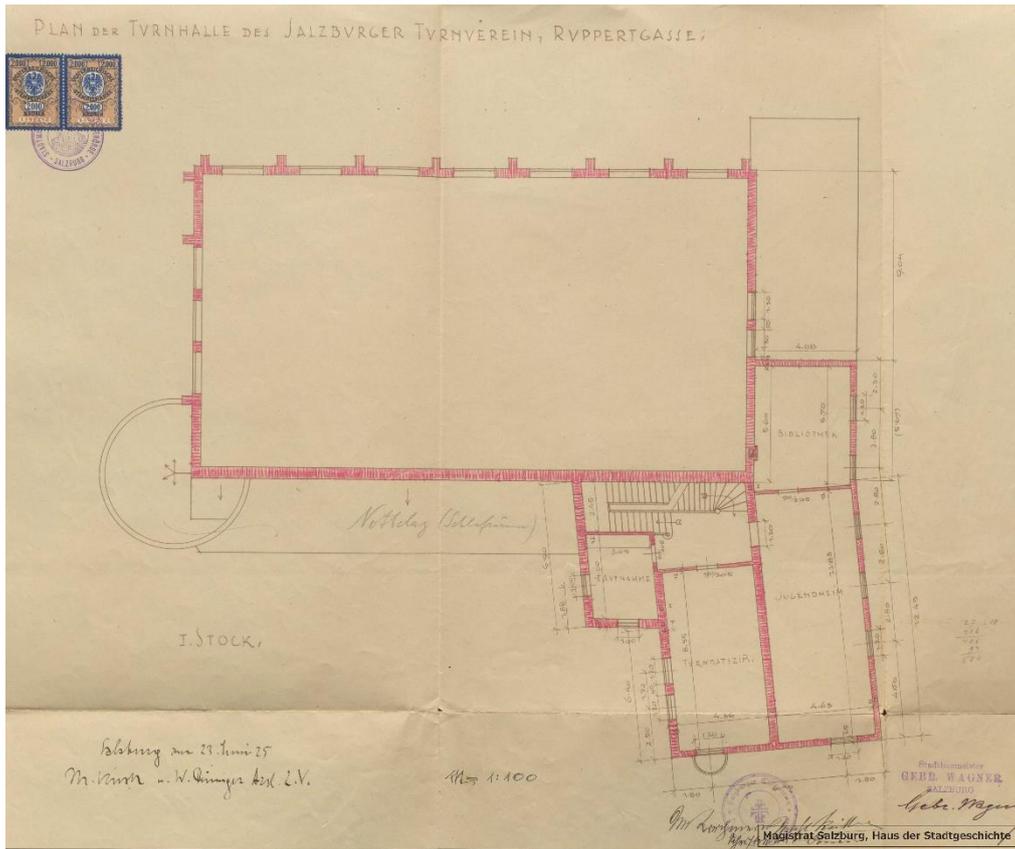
Einreichplan Obergeschoss 1925 © Architekt Daininger und Stadtbaumeister Gebr. Wagner
